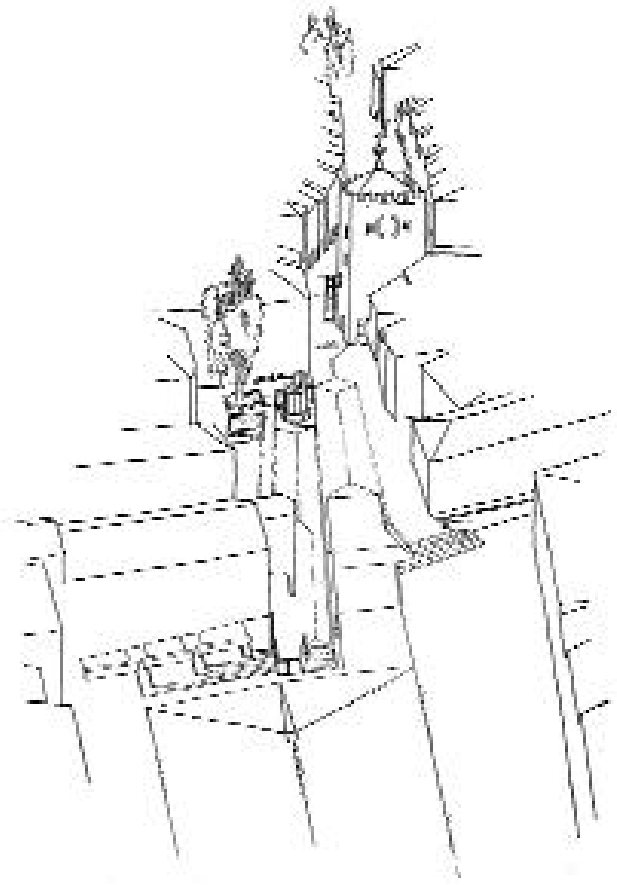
Piazza Ferretto, Torre civica, via Palazzo, planimetria generale
